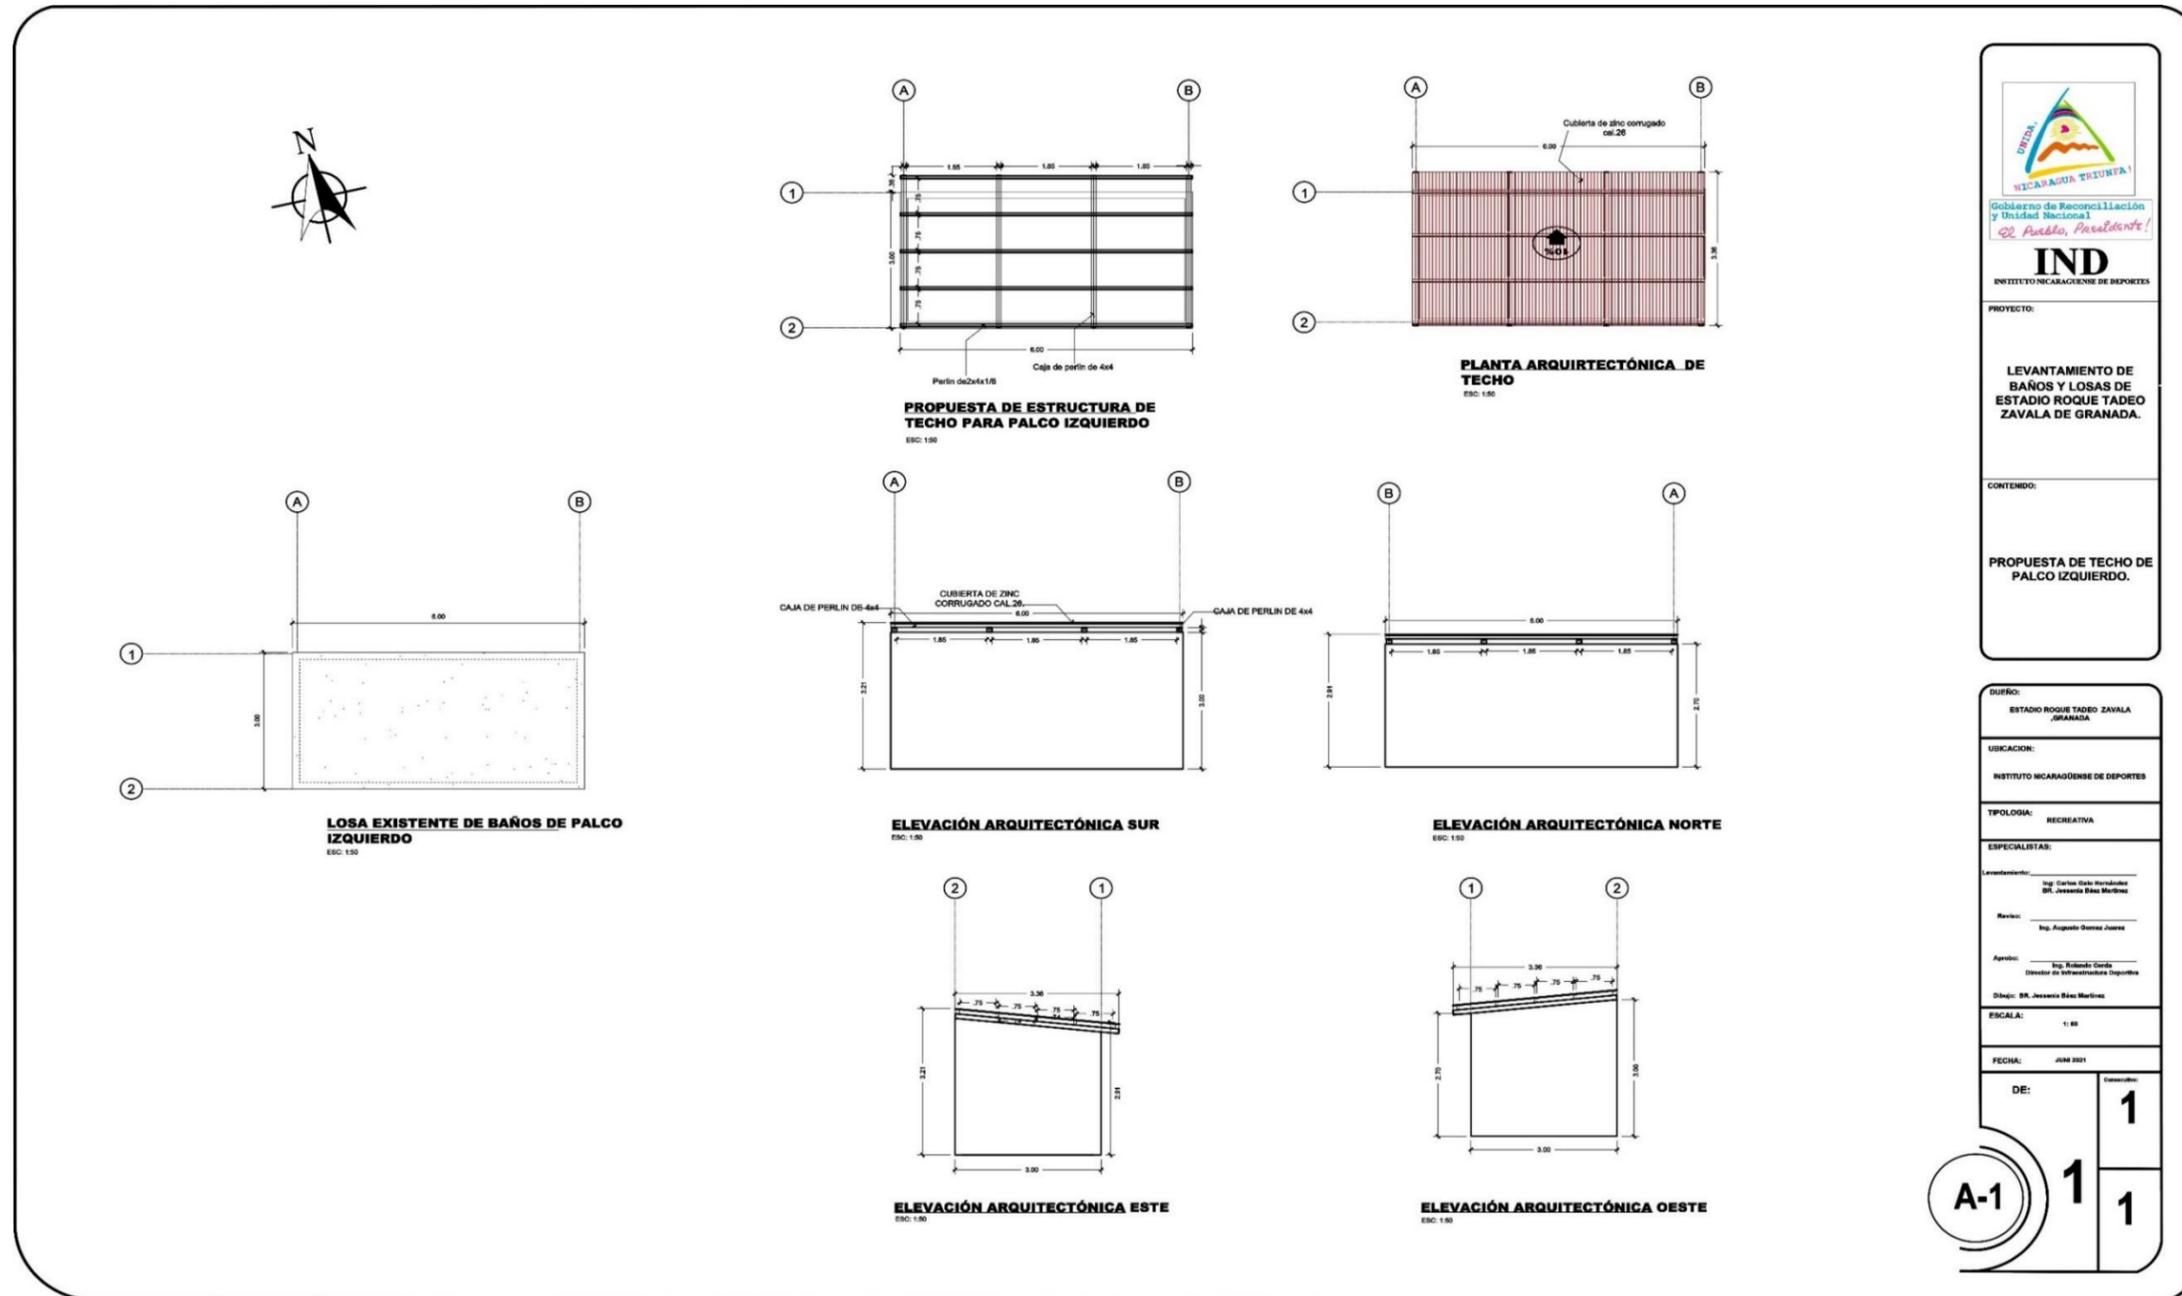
Propuesta de estructura de techo del área de palco izquierdo
